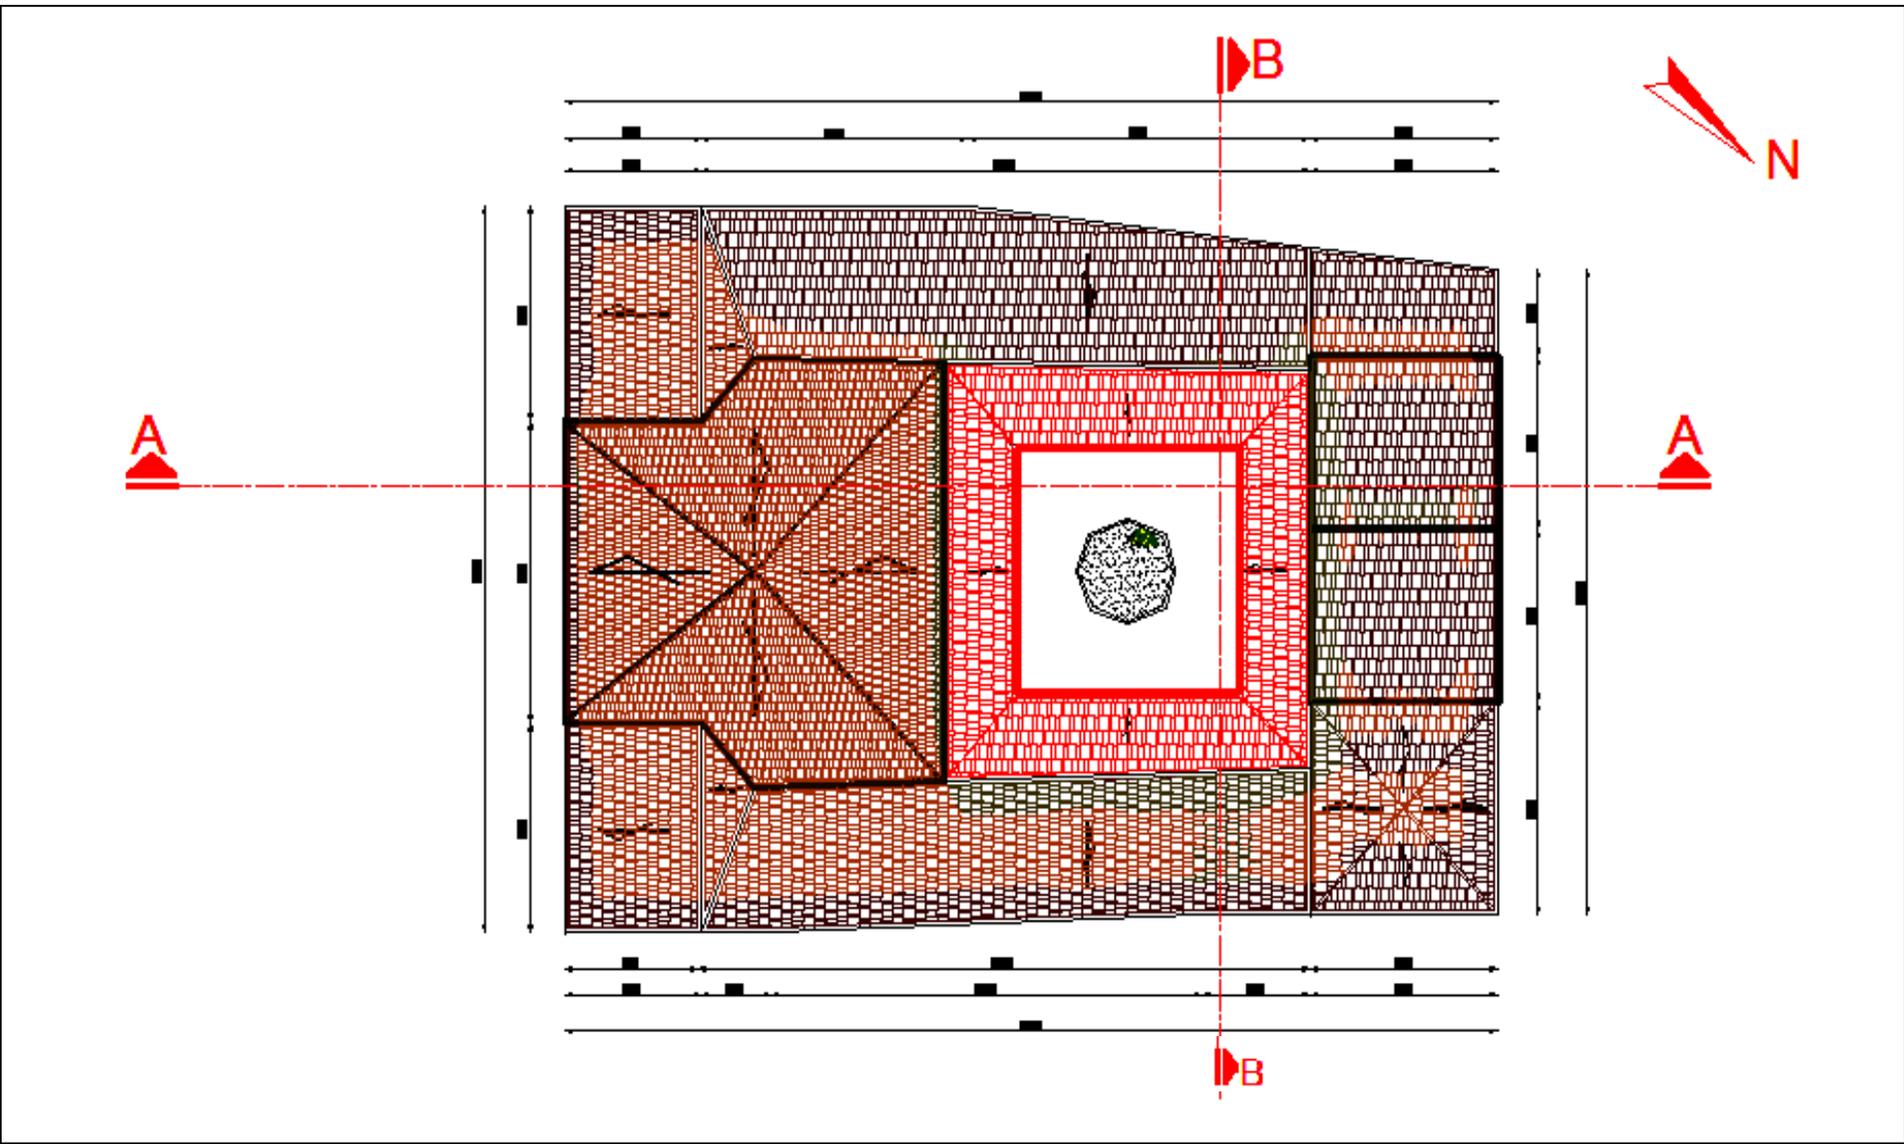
Plan de toiture. Echelle : 1/150. Source : auteur
